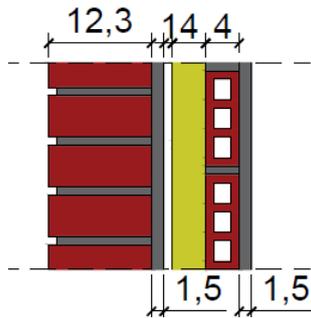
Plantas con elementos constructivos vivienda unifamiliar Picanya (Valencia).
